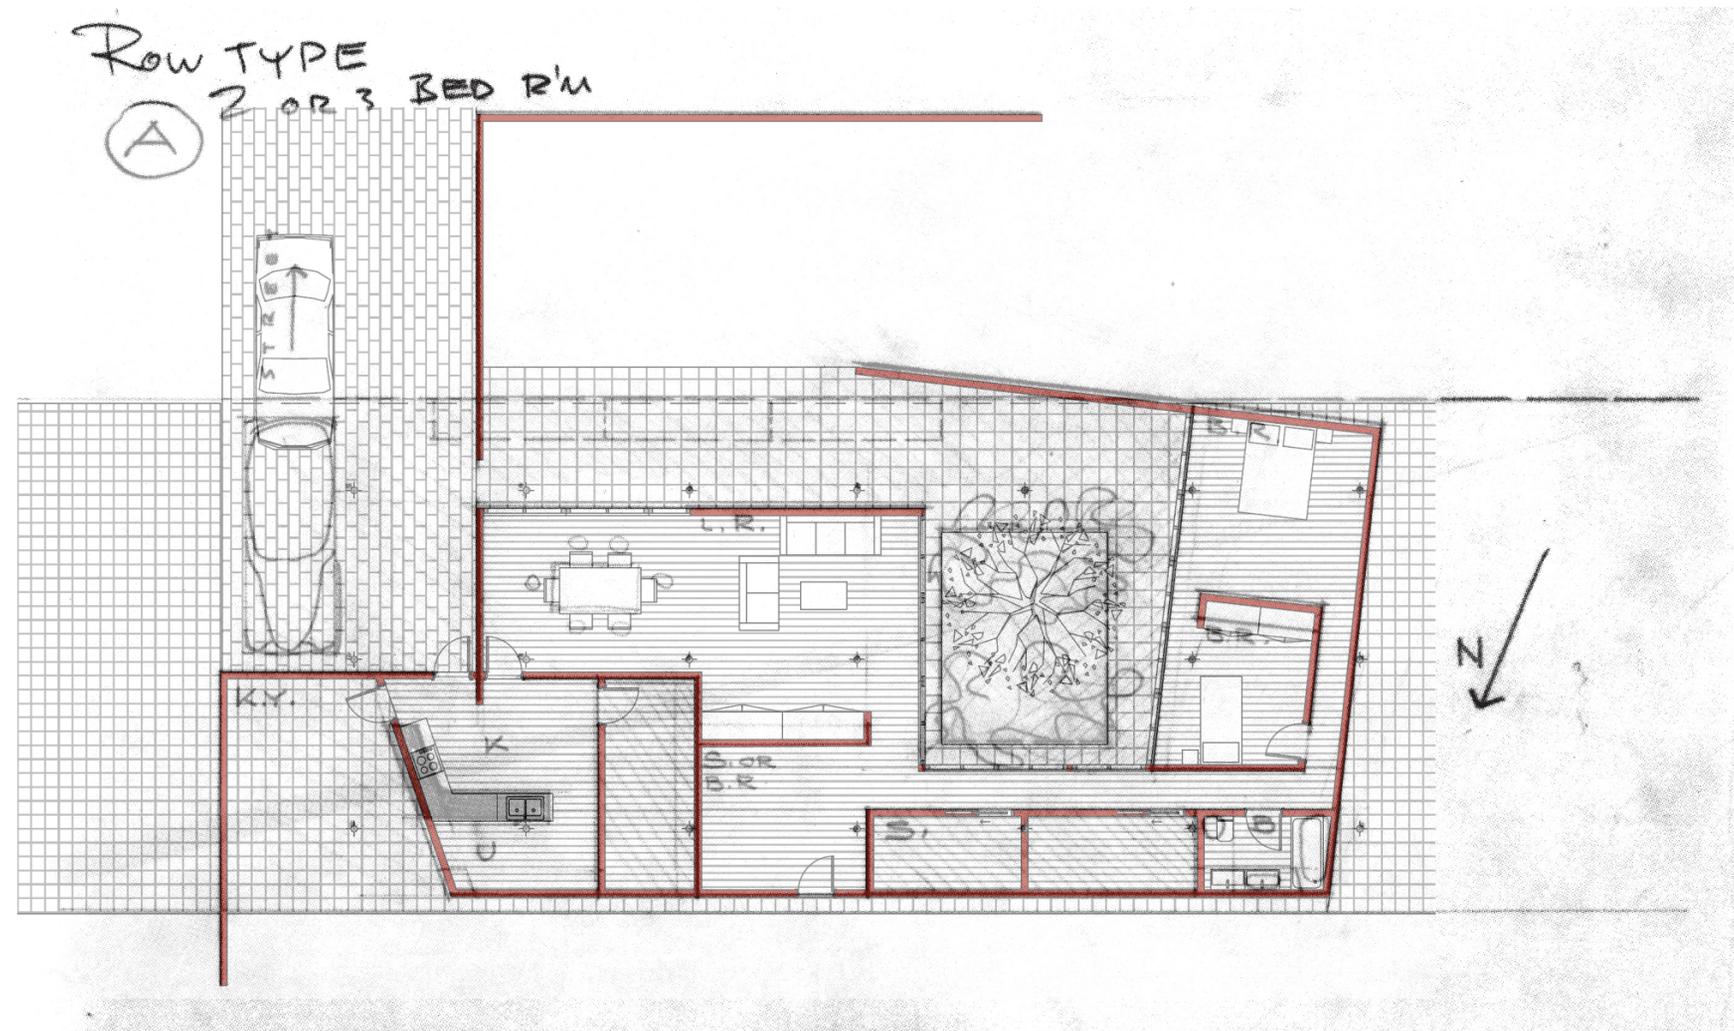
Superposición de la planta vivienda tipo A redibujada sobre el croquis original de Kahn.
